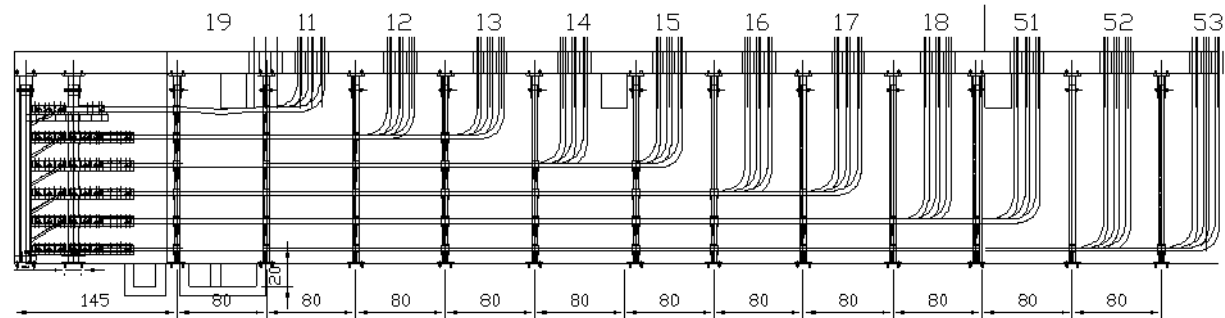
Equipos de media tensión. Planta y cortes.
